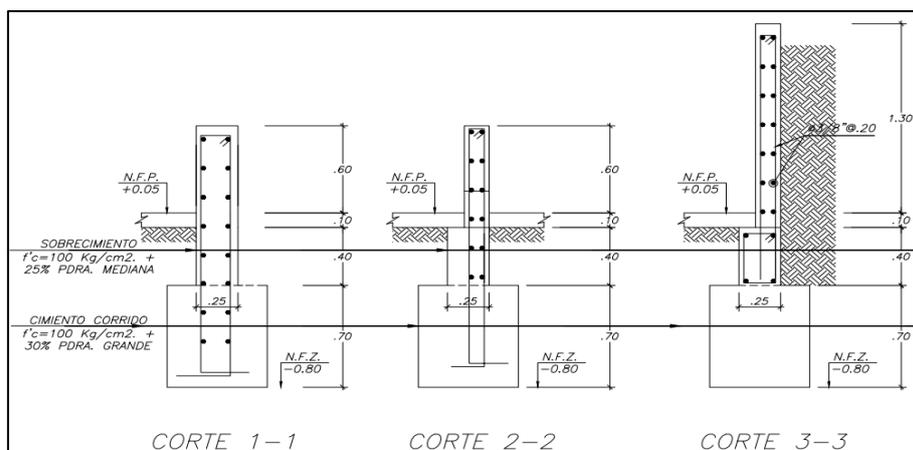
Propuesta de cimentación tipo C1 , C2 y C3 para el proyecto indicando refuerzo de sobre cimient armado.
